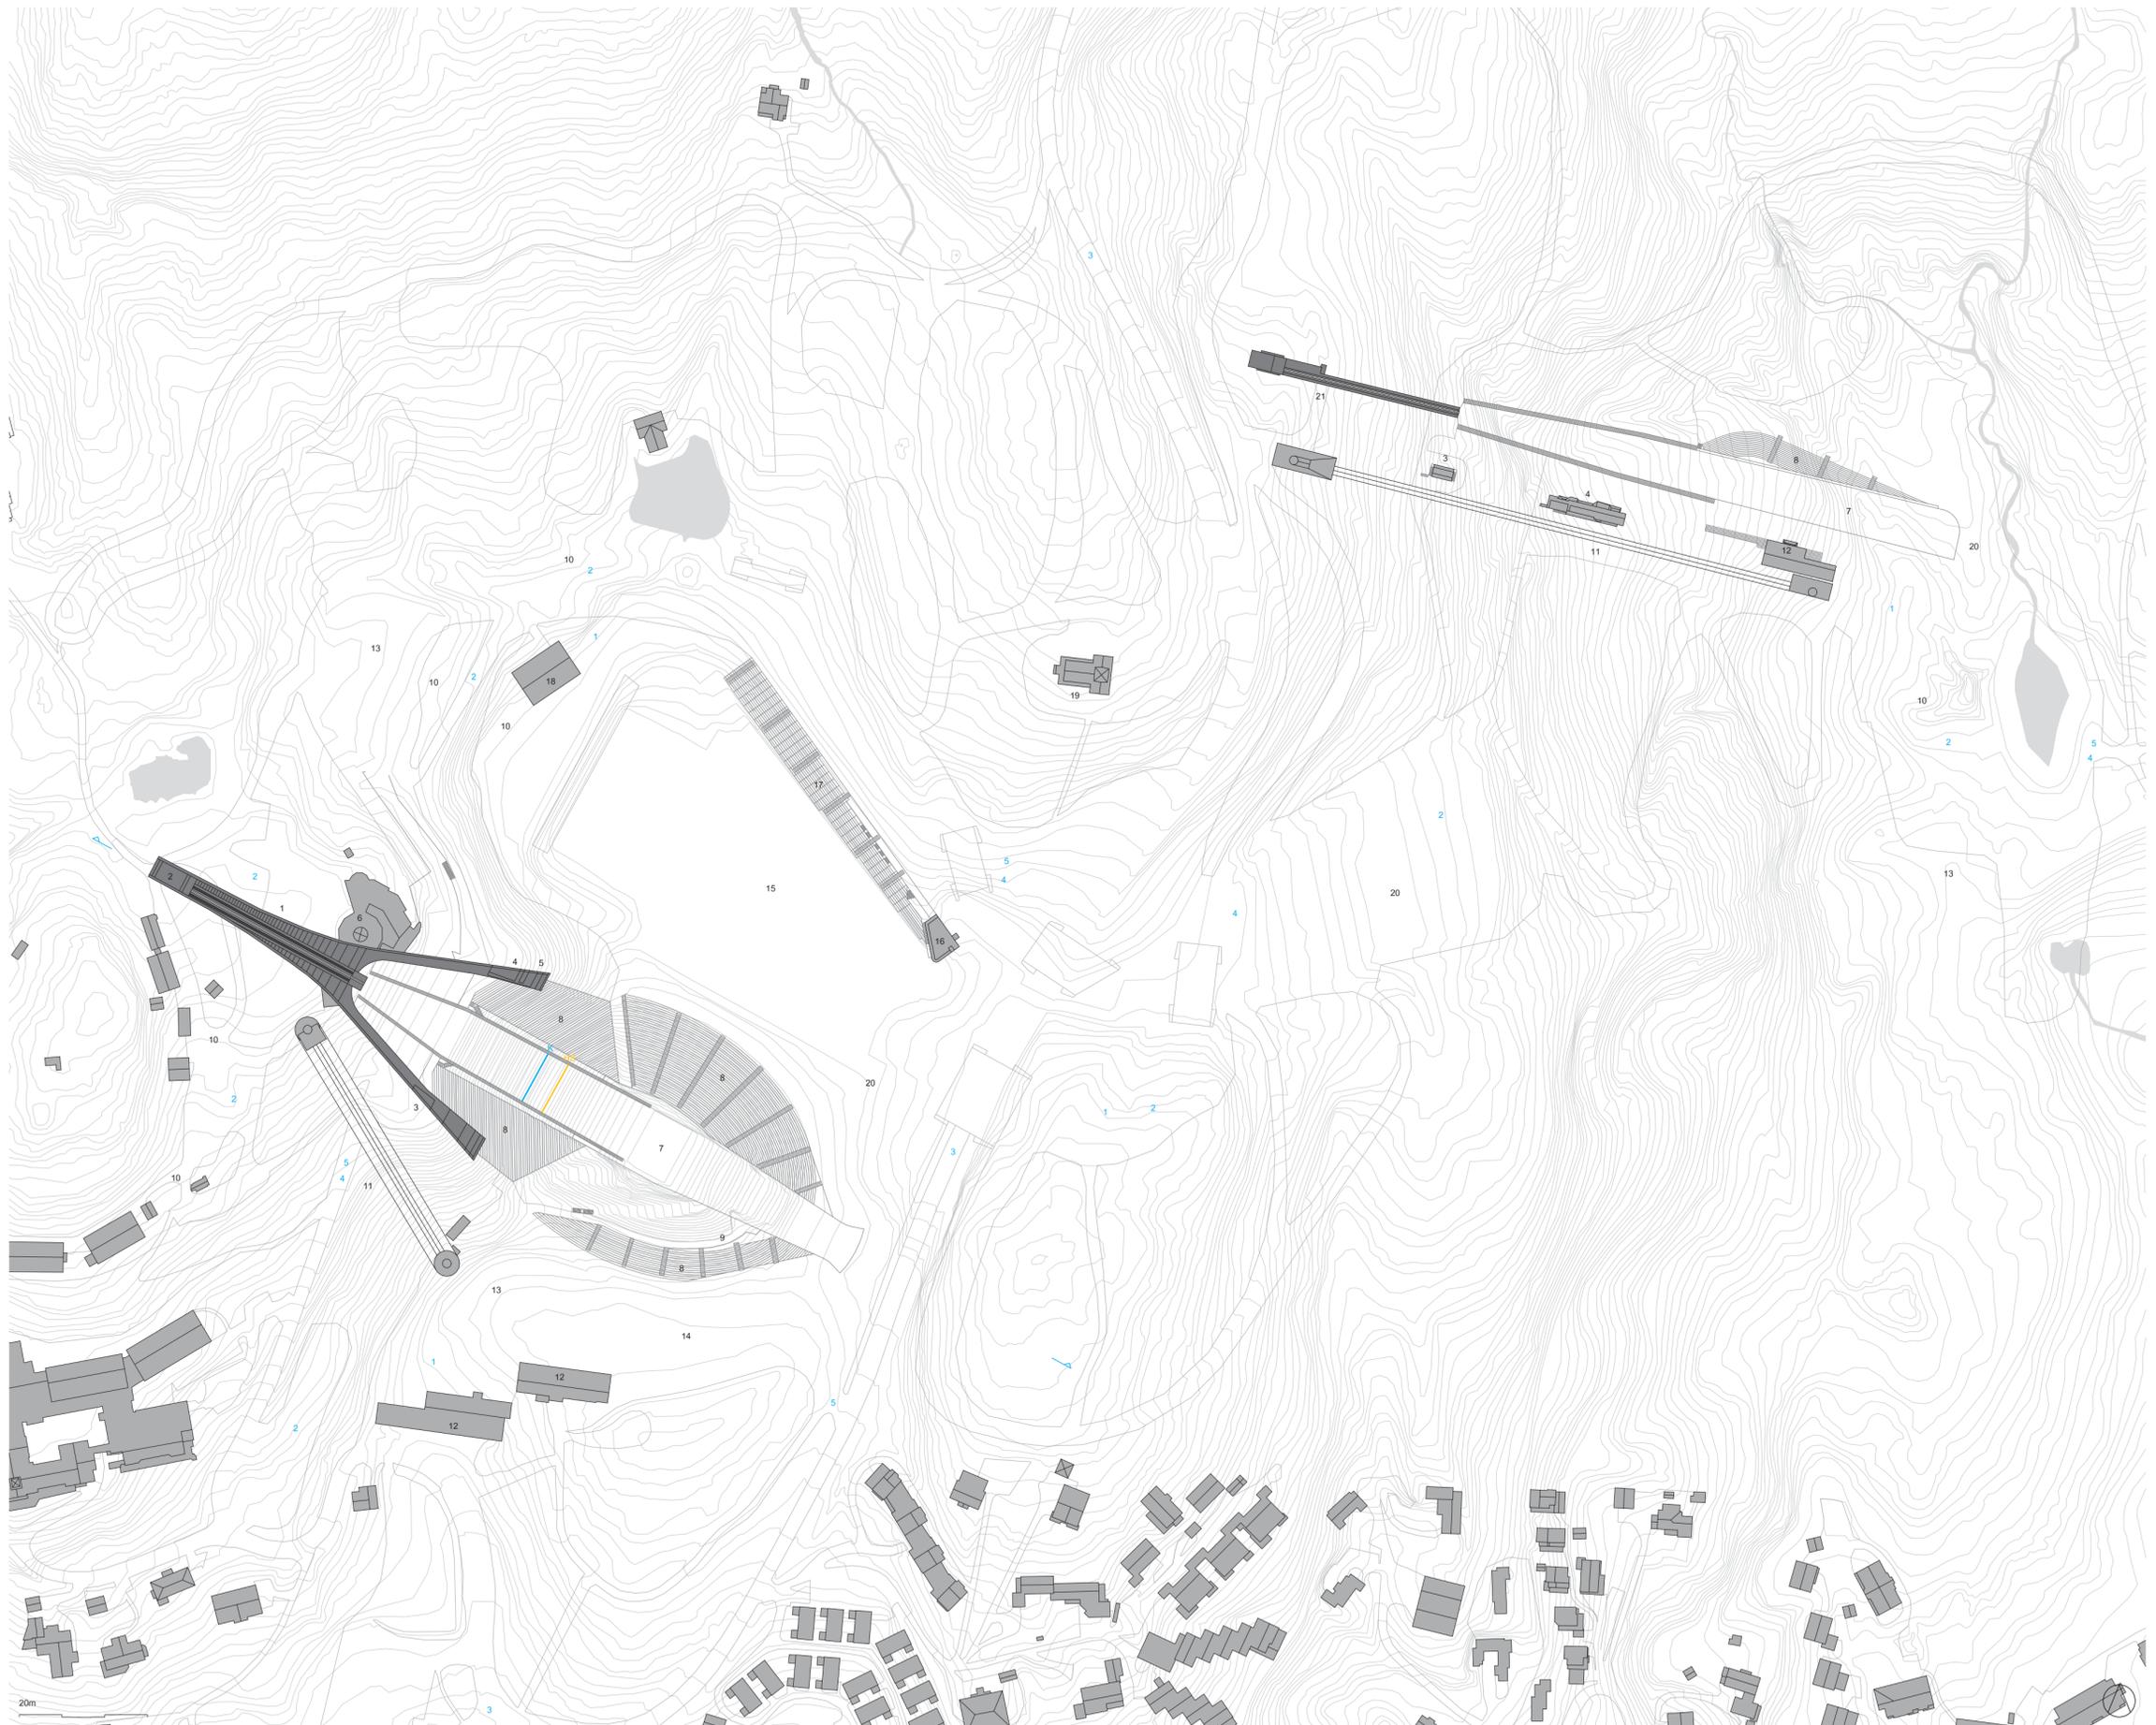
Grundriss Holmenkollen-Schanze Oslo M 1:2.000
